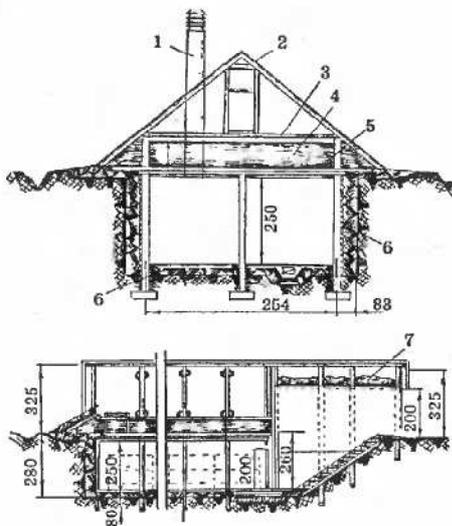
Поперечный и продольный разрезы подземного зимовника (размеры в см): 1 — верхний вытяжной канал; 2 — шифер; 3 — 6-сантиметровый слой сухой земли; 4 — соломенная резка; 5 — глиняная смазка; 6 — глина; 7 — земля с соломенной резкой
